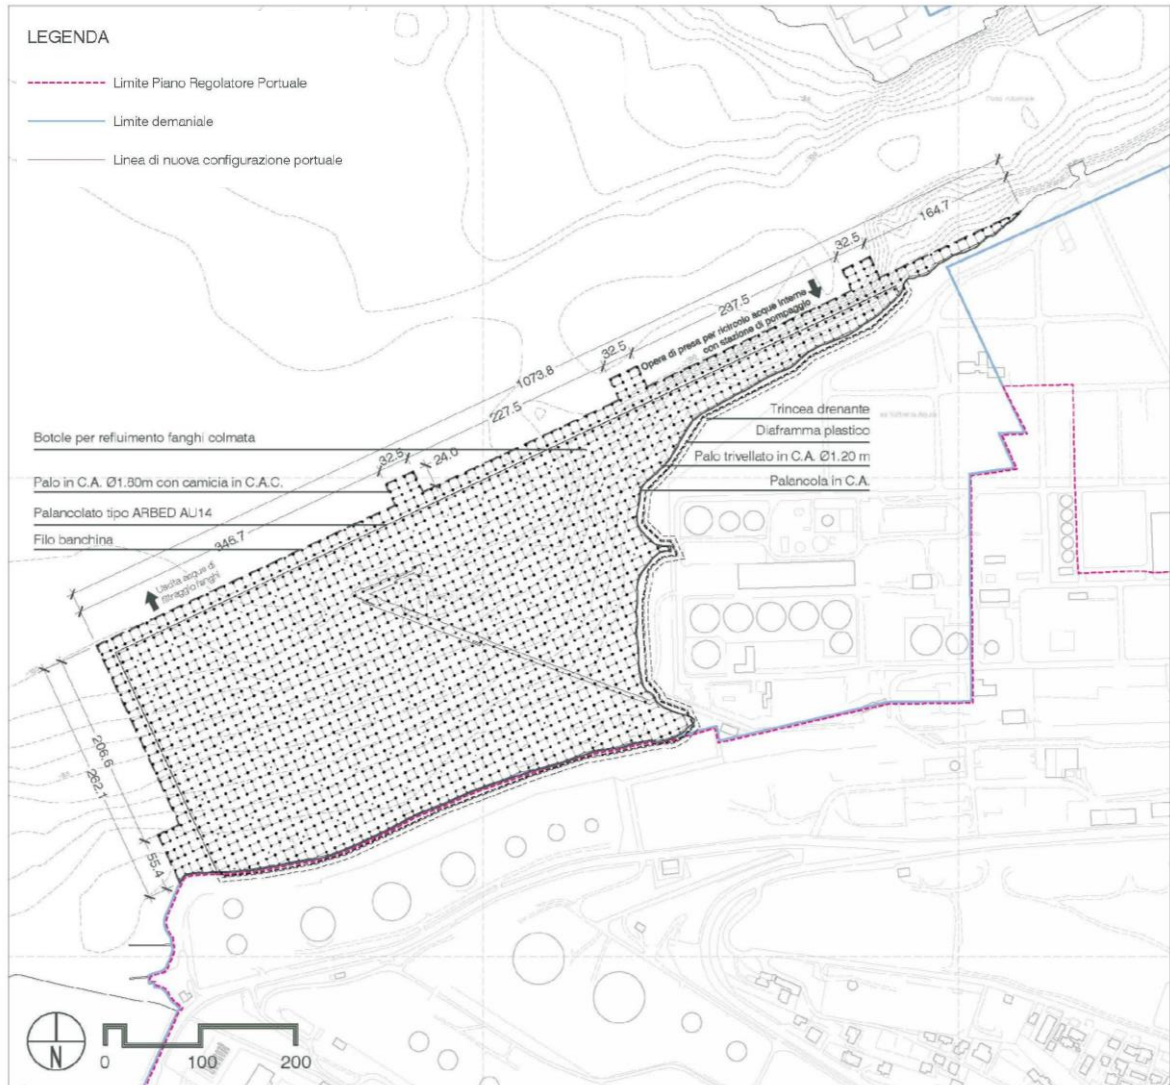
PLANIMETRIA TIPO PER LA CASSA DI COLMATA 05
